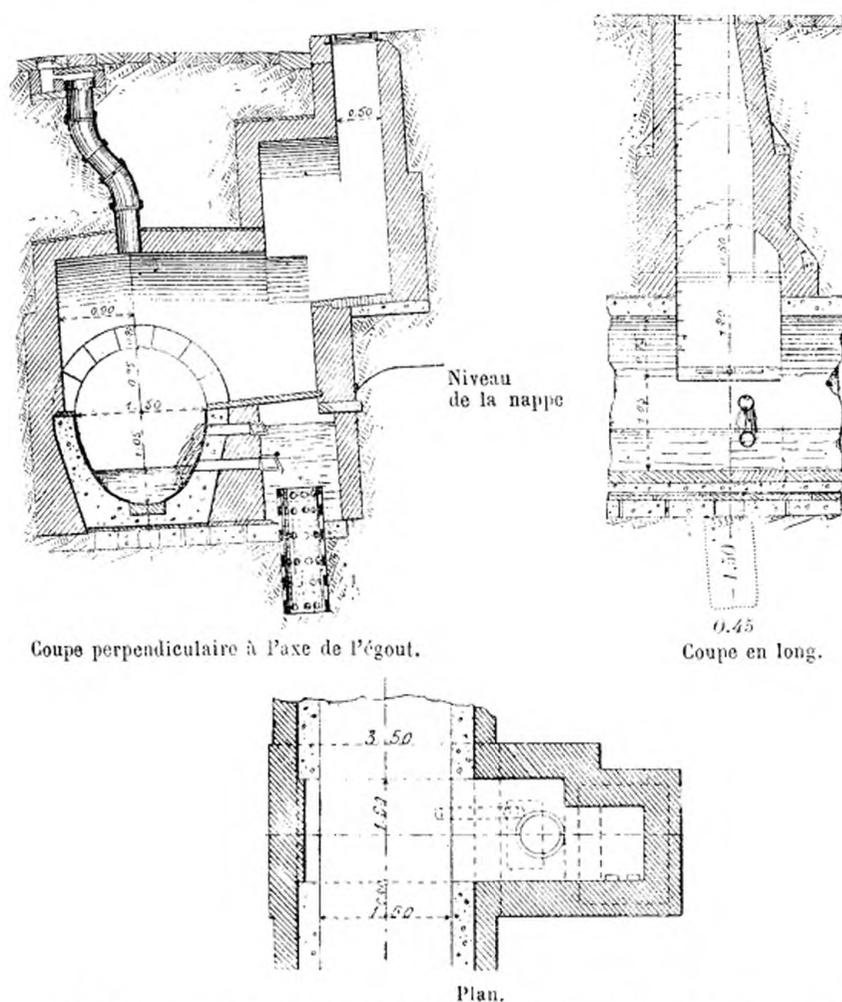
bis. — Un égout drainant la nappe souterraine à Milan. (Drenaggio saliente.)
